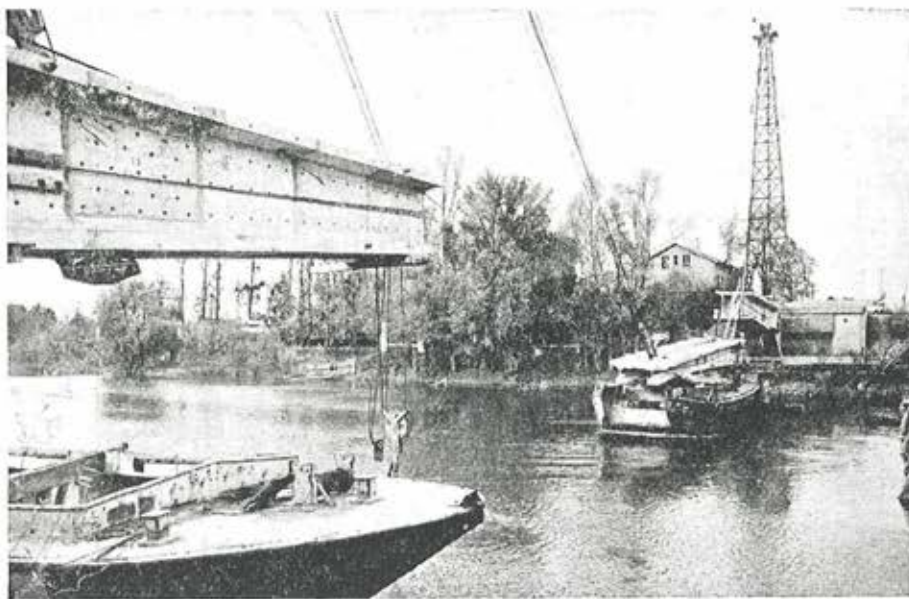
Puentes sobre el Marne: Colocación de un elemento prefabricado del centro del tramo.
